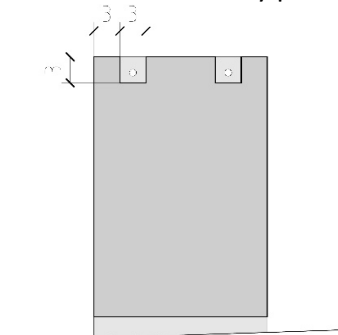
, Corte vertical, primera hilada, sobre faja de nivelación con ubicación de armadura de refuerzo.
